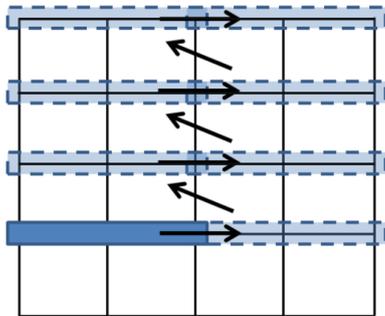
Pembagian Blok Denah pada Proyek Gedung Parkir di Kawasan Pura Besakih
